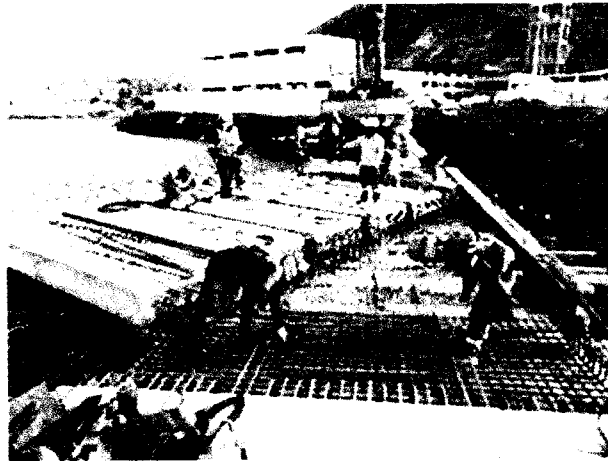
Transporte y colocación de losas y acero en juntas. Puente de acceso
